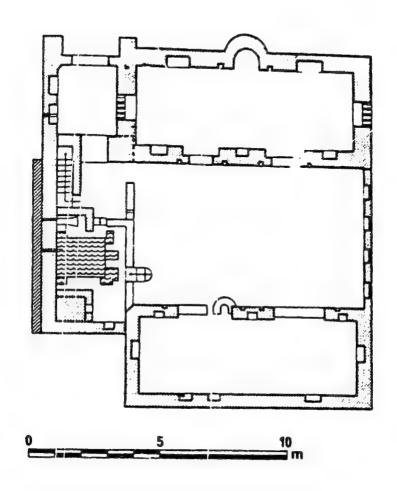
مسقط أفقي للمدرسة المعتبية ـ تعز
